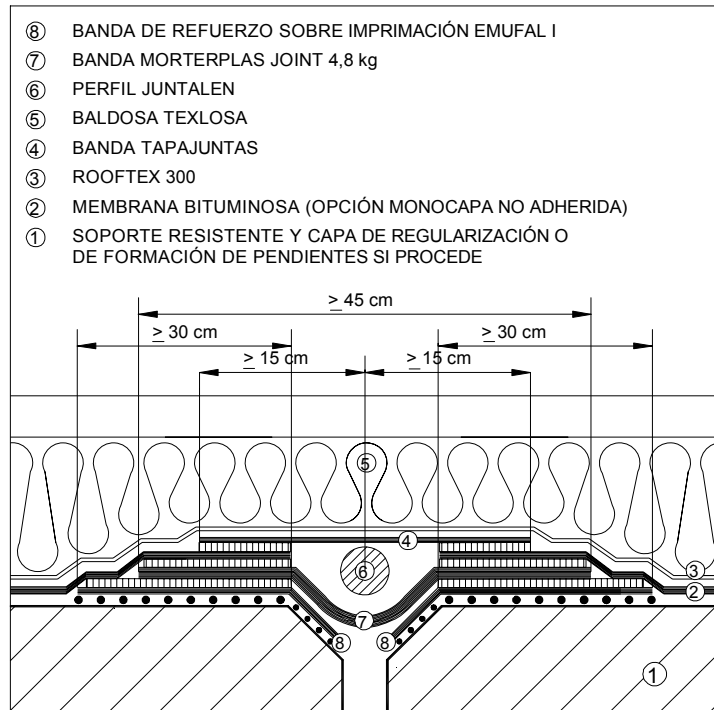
JUNTA ESTRUCTURAL CON MEMBRANA BITUMINOSA
